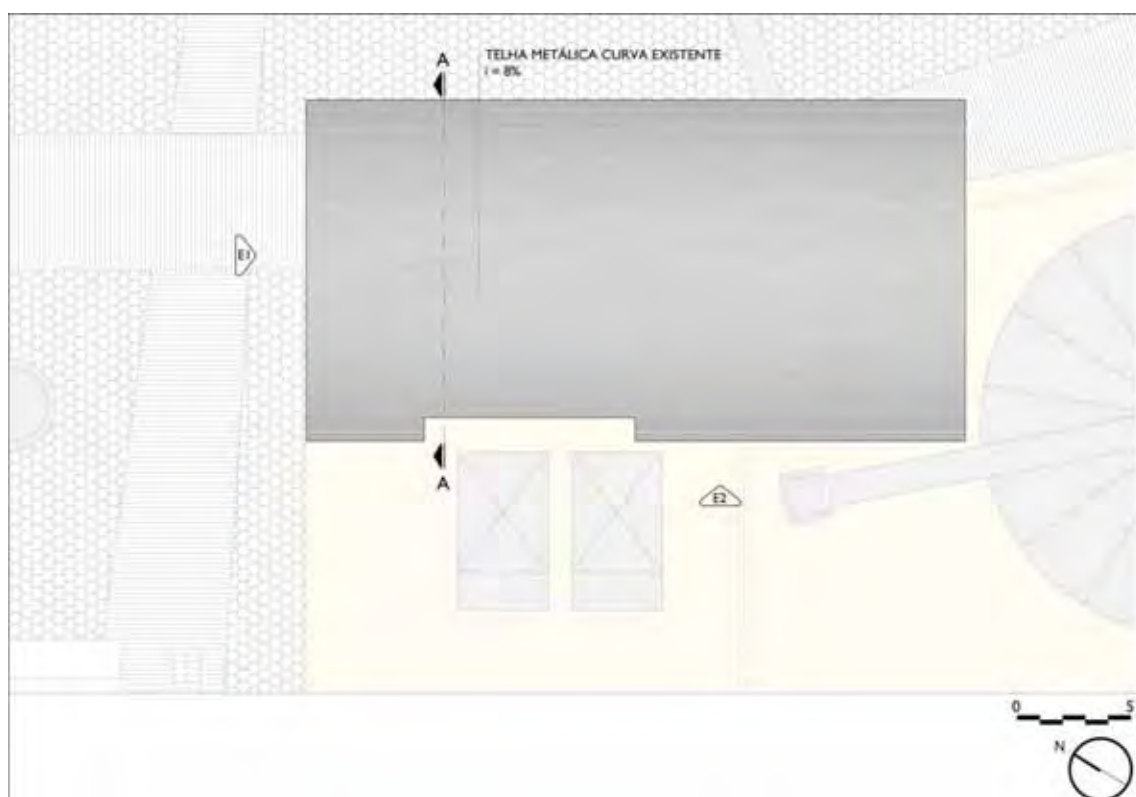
Planta de cobertura do edifício de apoio. (Desenho da autora.)
